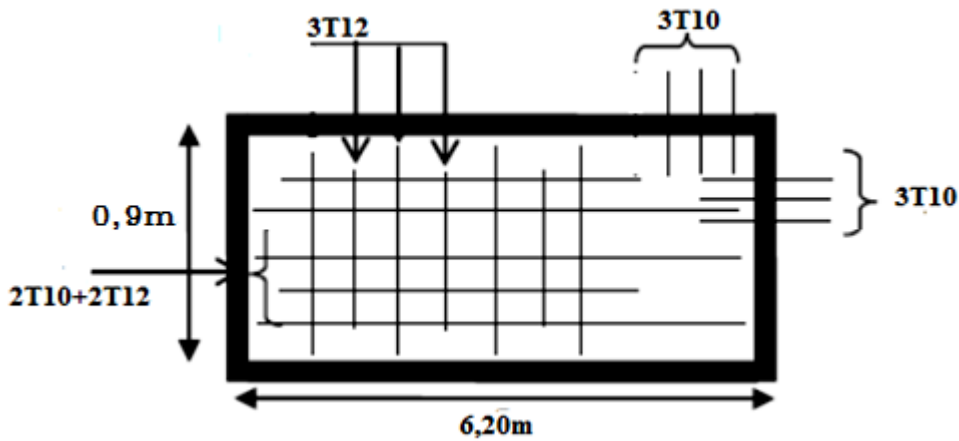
Ferrailage de la dalle pleine du contrepoids
